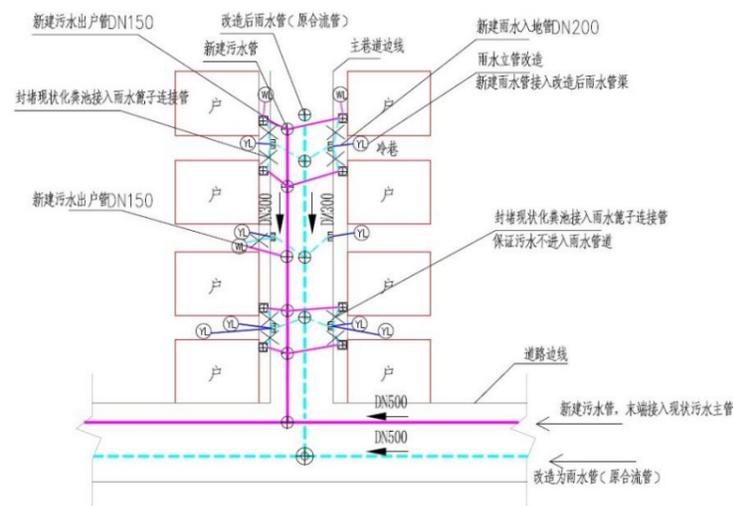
主巷（1.0~2.5 米）排水改造平面示意图（一）
